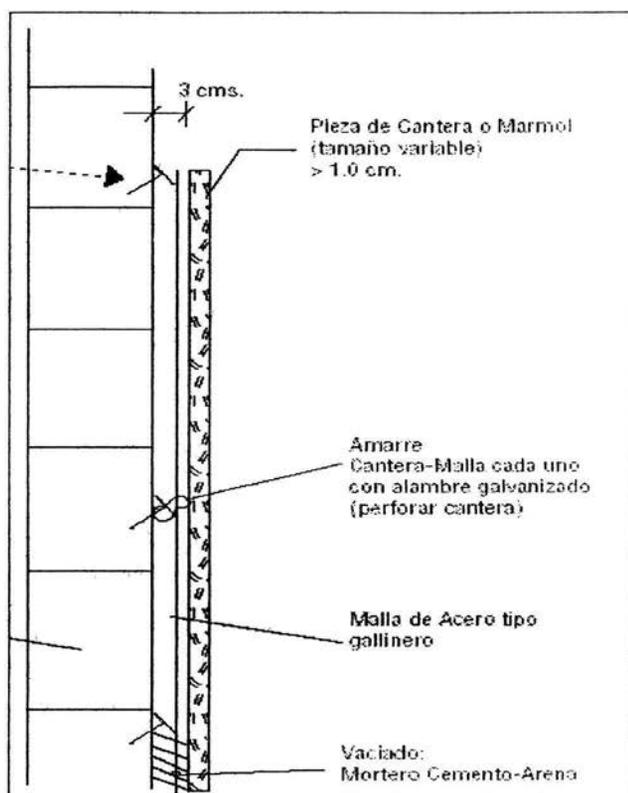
En la figura se muestra un detalle de colocación de mármol de espesor mayor de 1.00 cm sobre muro de bloques de concreto celular.
